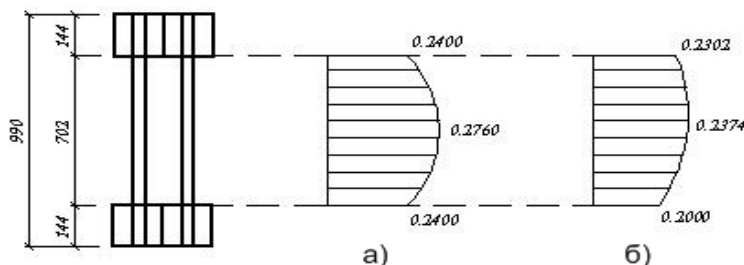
Эпюры касательных напряжений в фанерных стенках:
